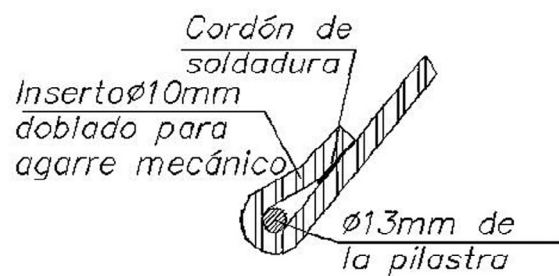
DETALLE DE UNIÓN ENTRE INSERTO DE ACERO Y BARRA DE ACERO DE LA PILASTRA.
